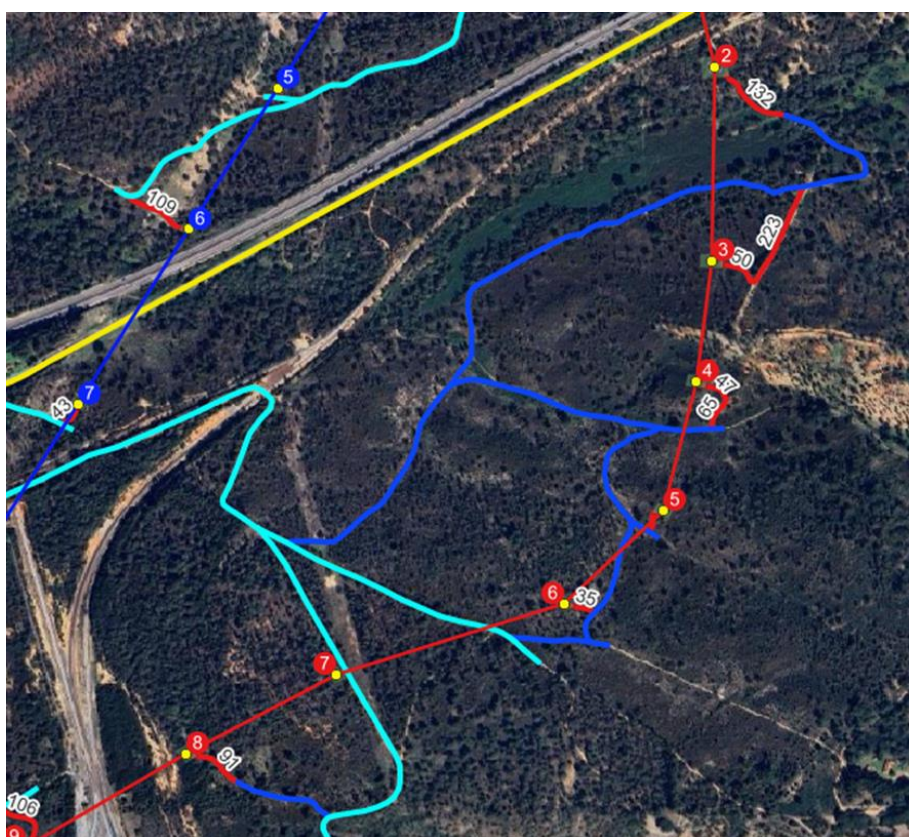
Planta de acesso aos apoios 2 a 8 (SC2)
